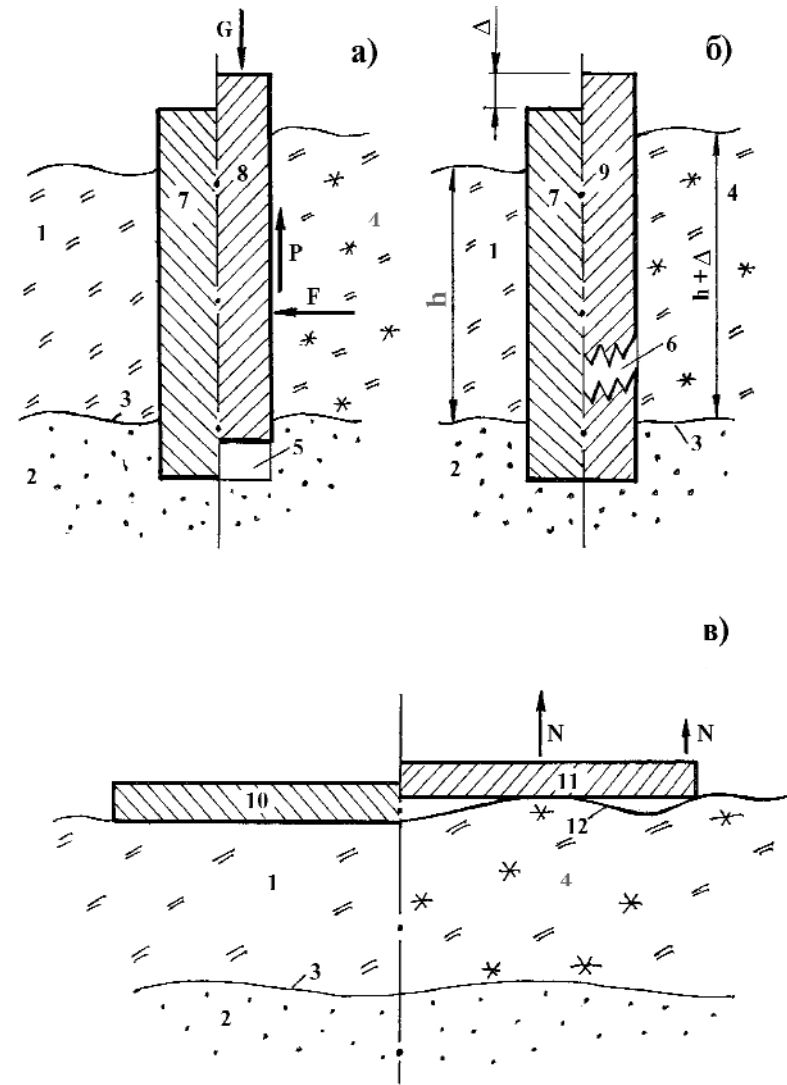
Схемы, поясняющие поведение фундамента на пучинистом грунте. На каждой схеме слева показано положение фундамента на вспученном пучинистом грунте (т.е. летом), справа — на вспученном пучинистом грунте (т.е. зимой): а, б — столбчатый фундамент, заглубленный ниже уровня про-
